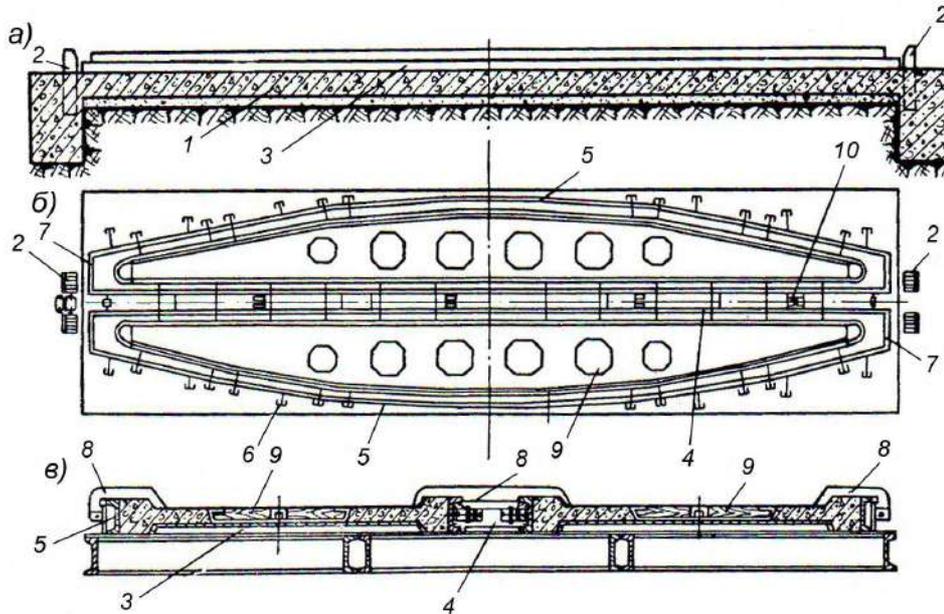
Стендовая силовая форма для изготовления железобетонных балок длиной 18,0м: а – разрез по основанию стенда; б – план; в – поперечный разрез; 1 – железобетонный стенд; 2 – торцовые упоры; 3 – поддон с коробами для образования проёмов в полке балок; 4 – разделительный съёмный вкладыш между двумя балками; 5 – бортовая опалубка; 6 – винты для передвижки и раскрепления бортоснастки; 7 – торцовые борта формы; 8 – шарнирные съёмные рамки (ваймы); 9 – вкладыши для образования проёмов; 10 – стенд для электронагрева арматурных стержней
